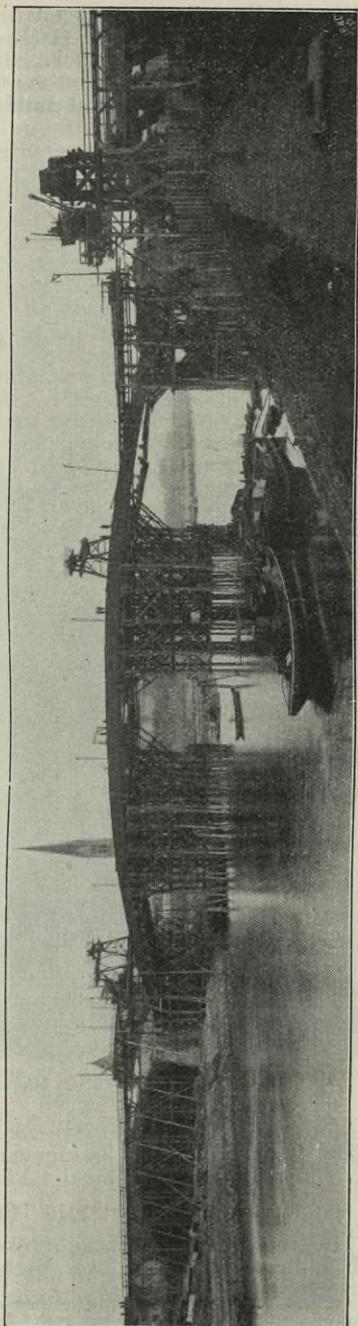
Straßenbrücke über den Neckar in Mannheim, Montagerüstungen.
